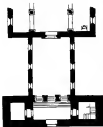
Vorkirche zu Fachsenelle nach Gerzangs Plan.
